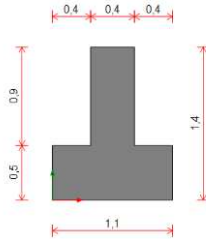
Geometria tipo trave a T rovescia di fondazione
